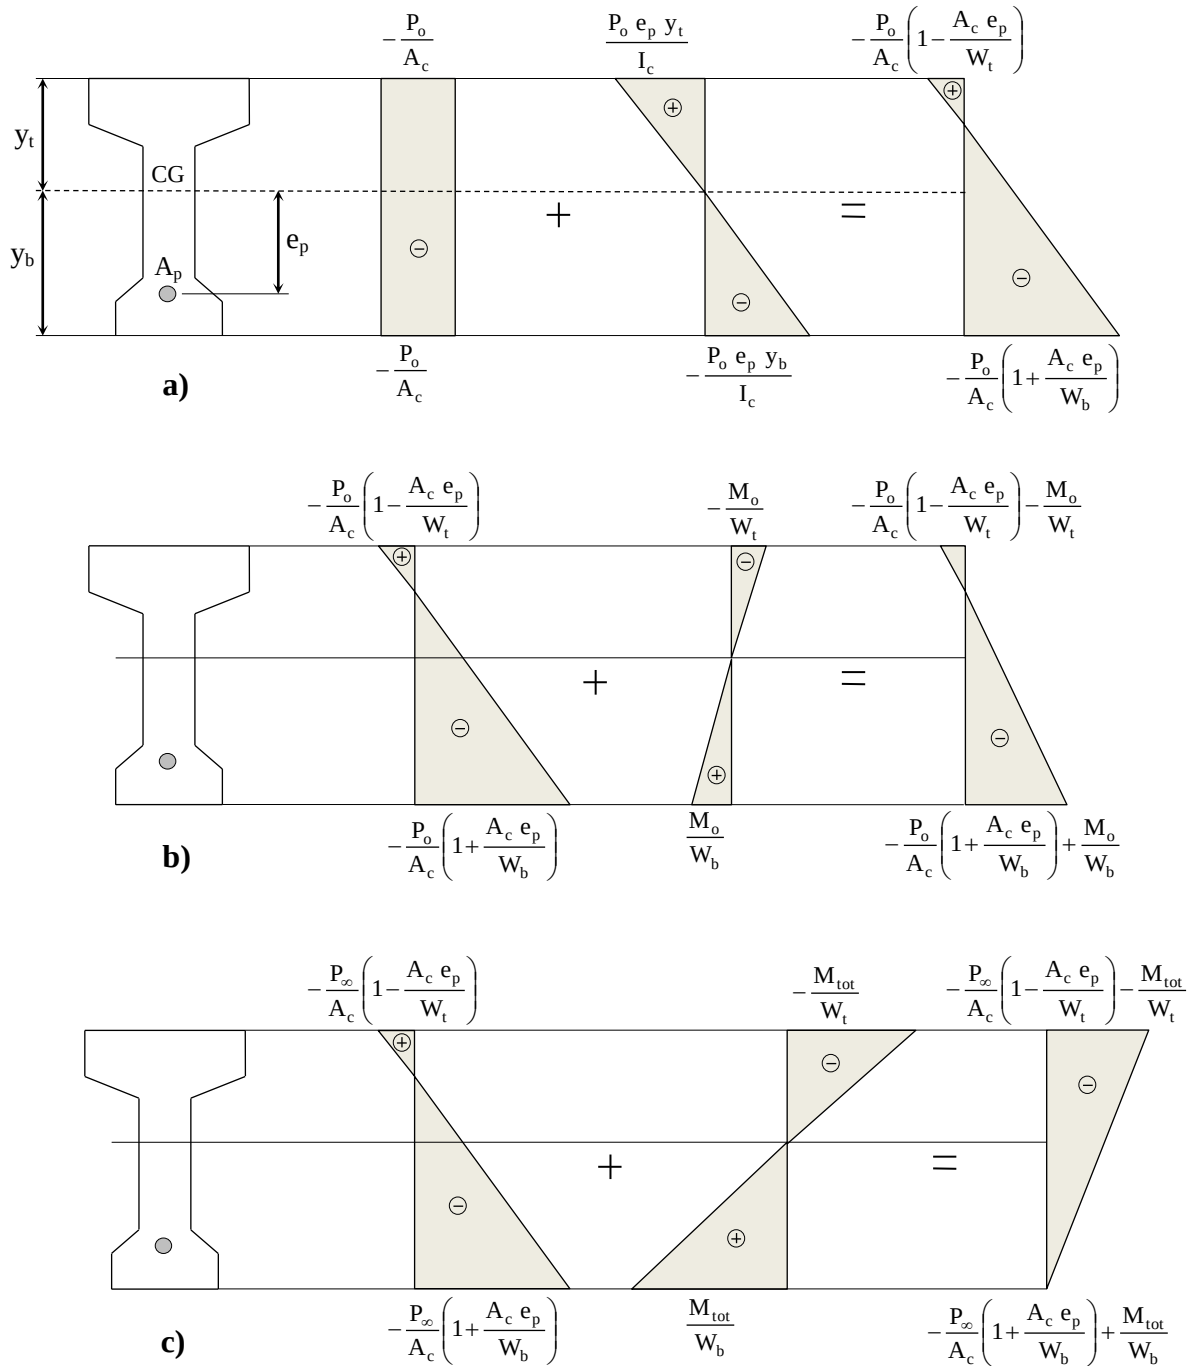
Diagramas de tensões elásticas no concreto de seção não fissurada de viga.
